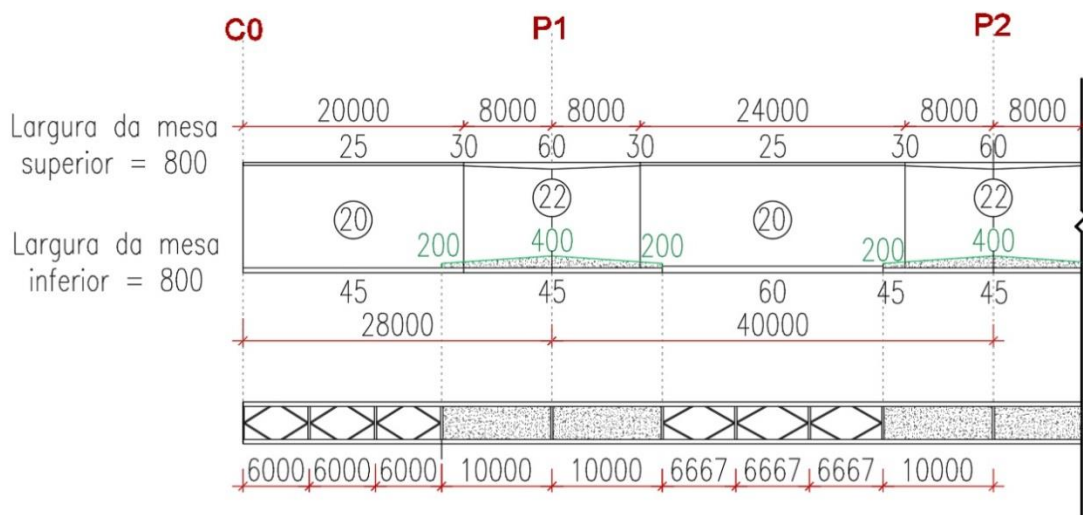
Corte longitudinal da estrutura metálica principal junto a laje inferior e vista inferior do tabuleiro com dupla ação mista (dimensões em mm)
